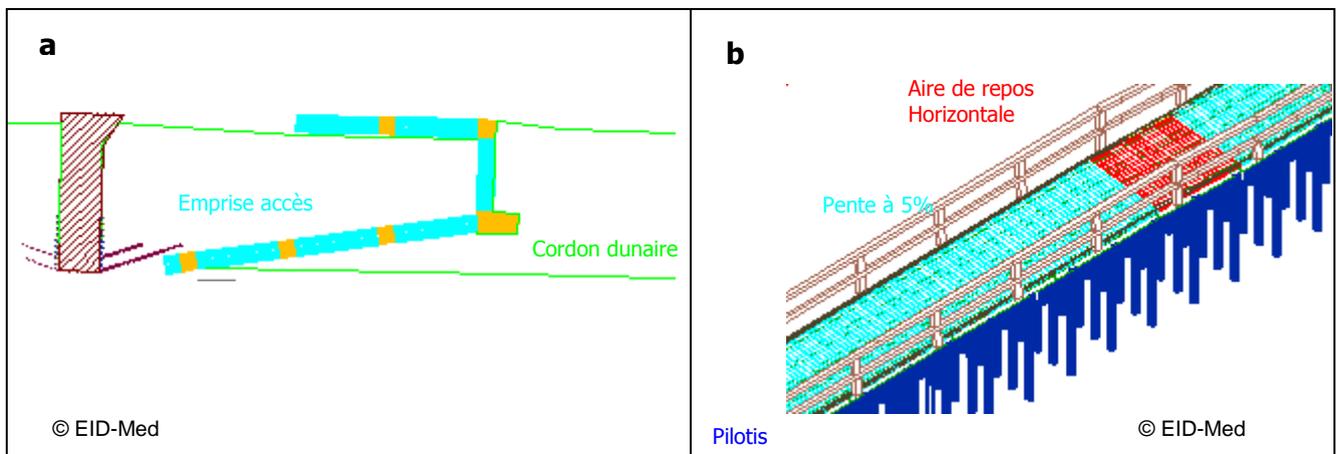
a) Vue en plan d'un schéma de principe de rampe handicapés; b) Vue de détail en 3D.
